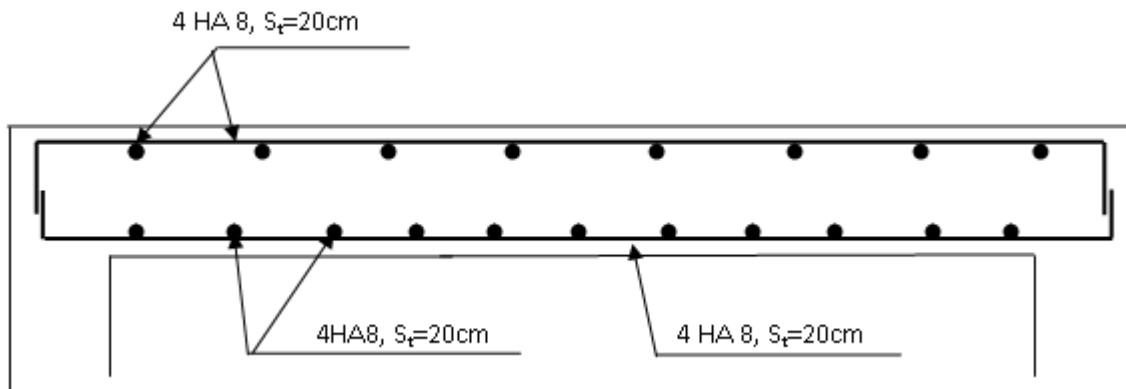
Plan de ferrailage de la salle machine suivant x-x et y-y.
